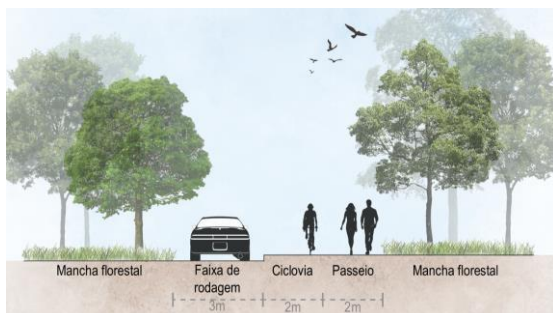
Perfil proposto da Cont. da Rua da Ermida
